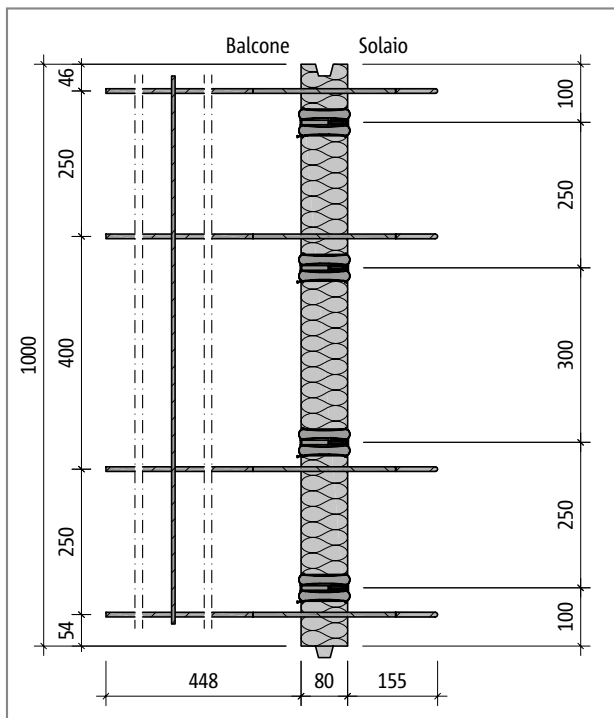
Schöck Isokorb® tipo Q10S, pianta del prodotto
